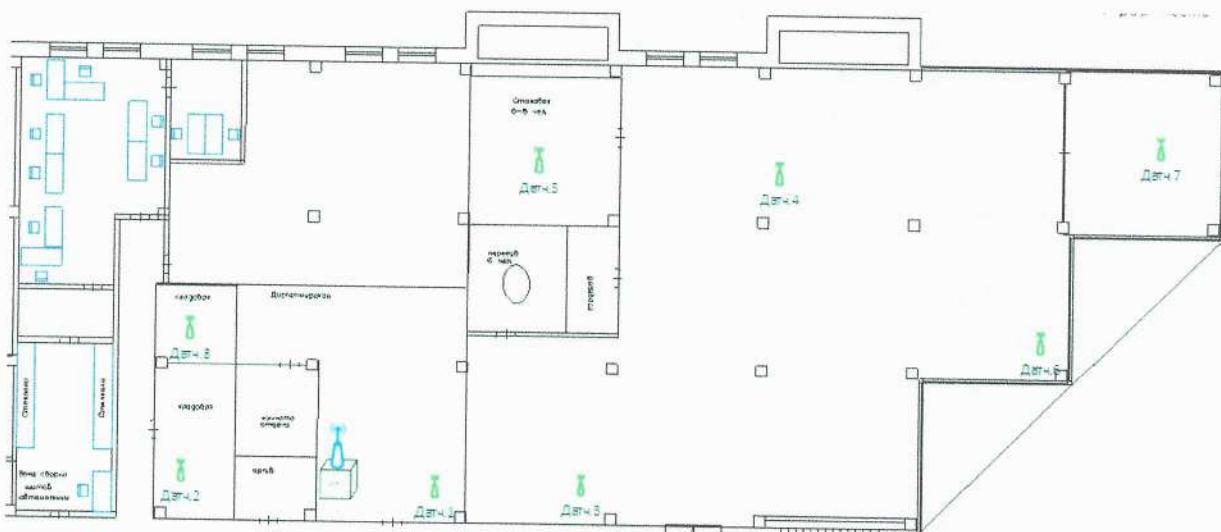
Фрагмент 2-го этажа корпуса 91. План размещения испытуемого оборудования.
